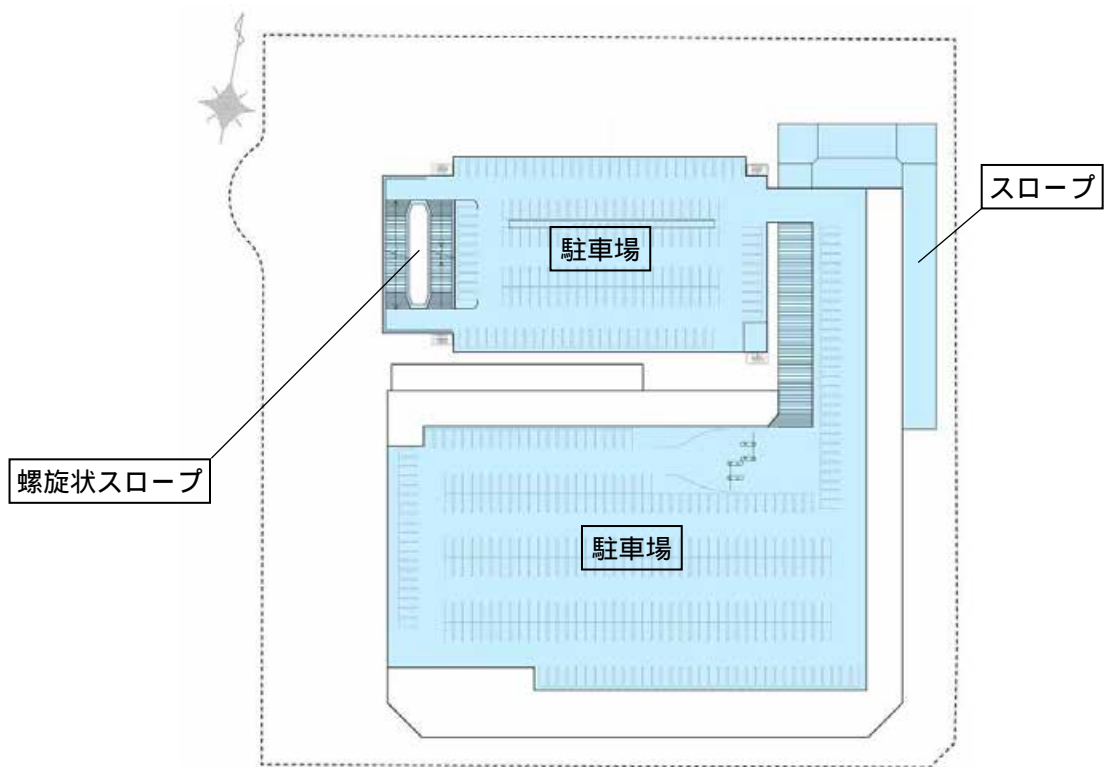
(5) 各階平面図(屋上階) 【評価書時】
